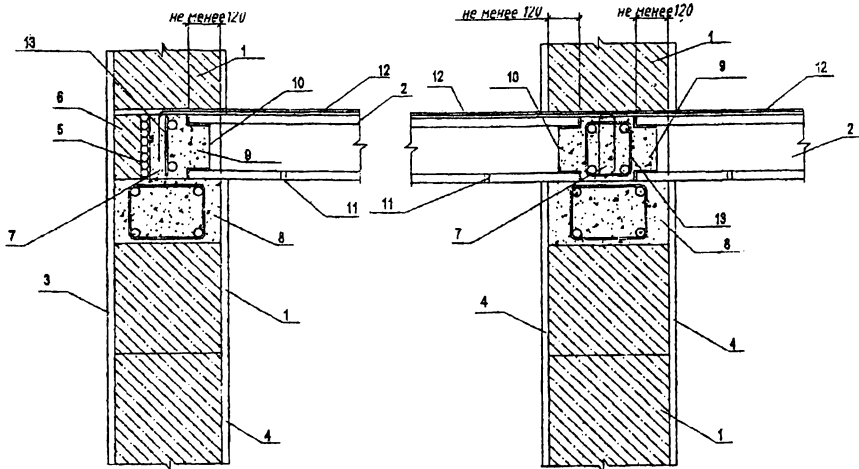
Схема опирания плит безопалубочного формирования на блоки из ячеистого бетона
